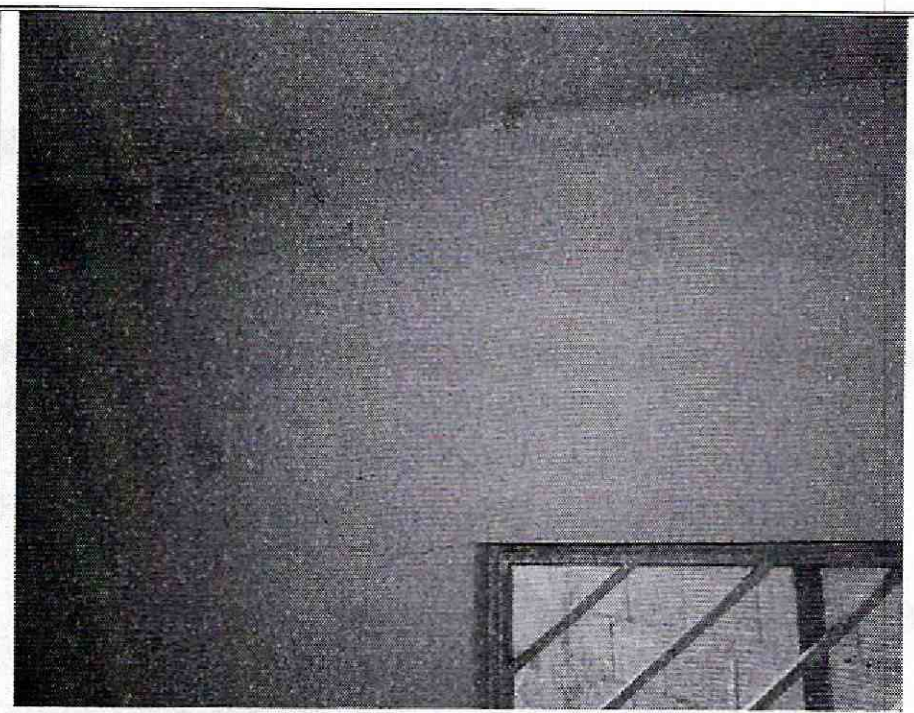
Fisuras en el muro sobre el costado sur de la vivienda de la Calle 50 C Sur No. 12 C - 33.
